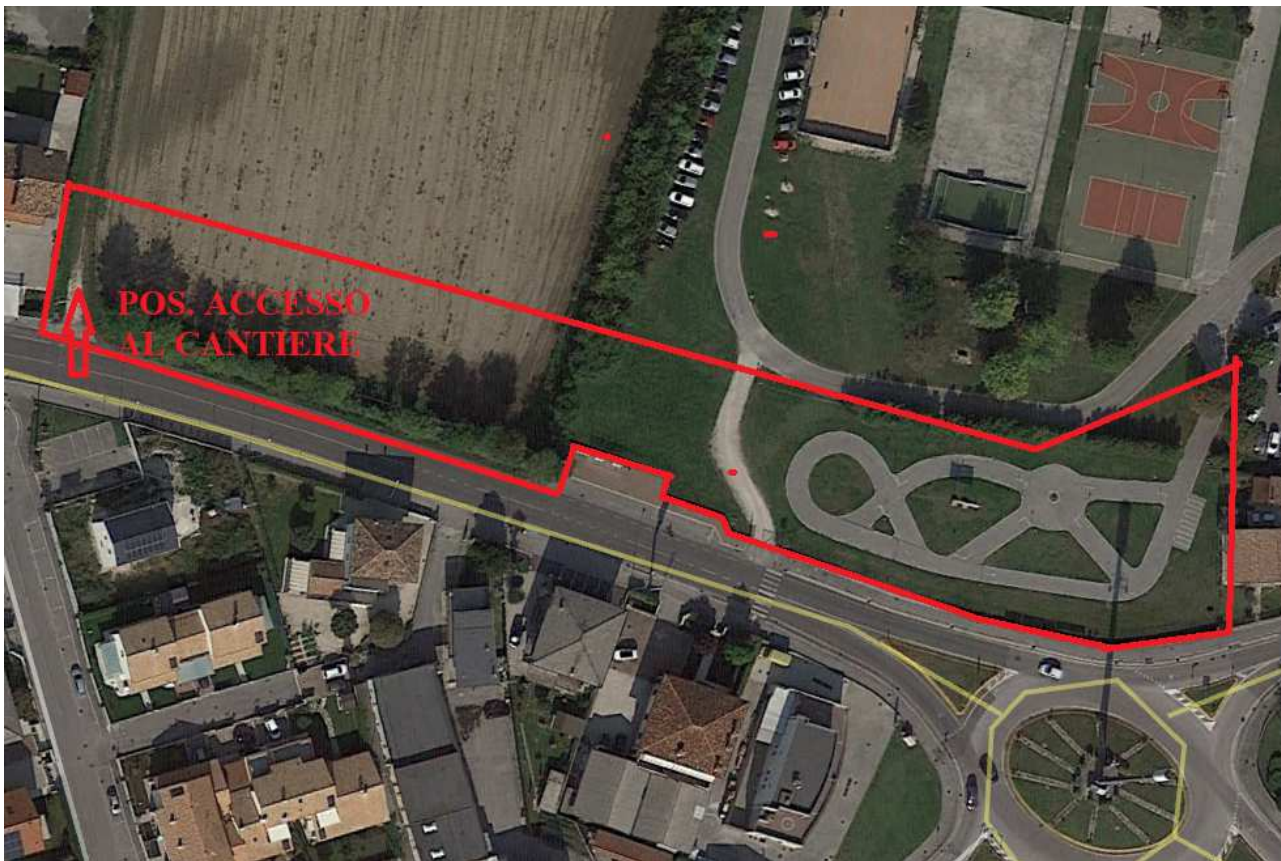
MACROFASE 1 - PERIMETRAZIONE DEL CANTIERE
